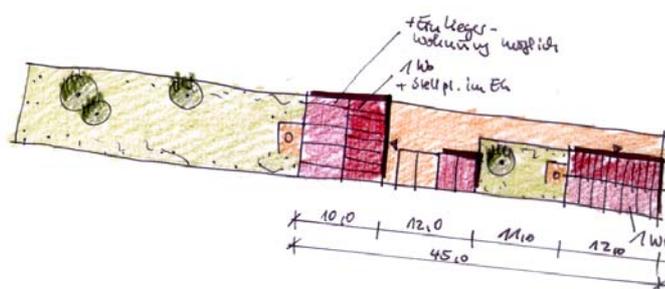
mögliche Bebauung – Vorstadtstraße 9, Variante 1
